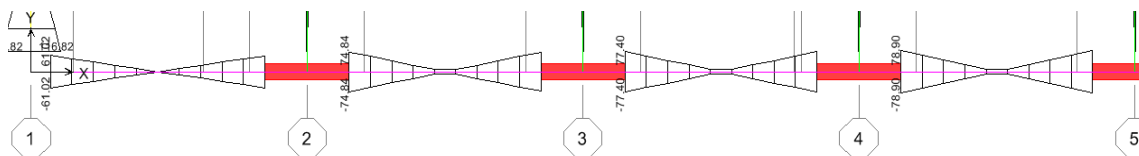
a. - Momentos, cortantes y acero colocado en vigas de la superestructura.
